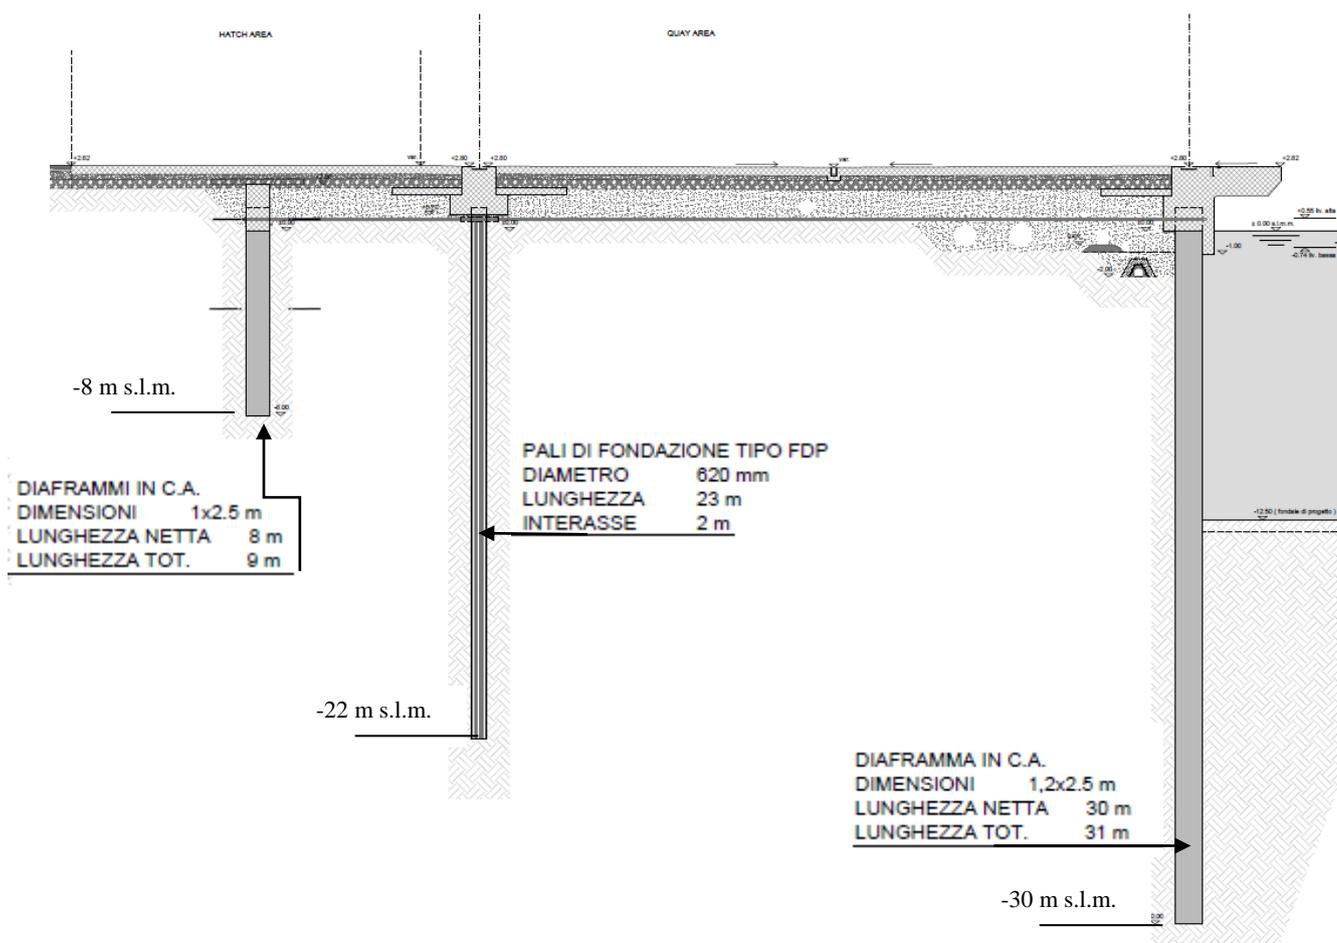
sezione di progetto di ancoraggio della nuova banchina
